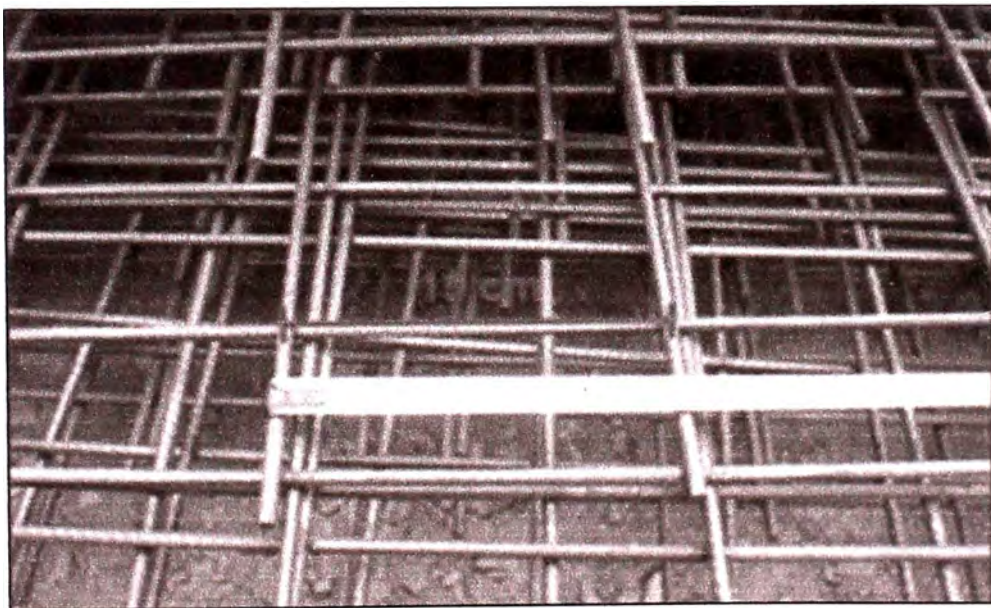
Refuerzo de Losa (8mm@15cm)
